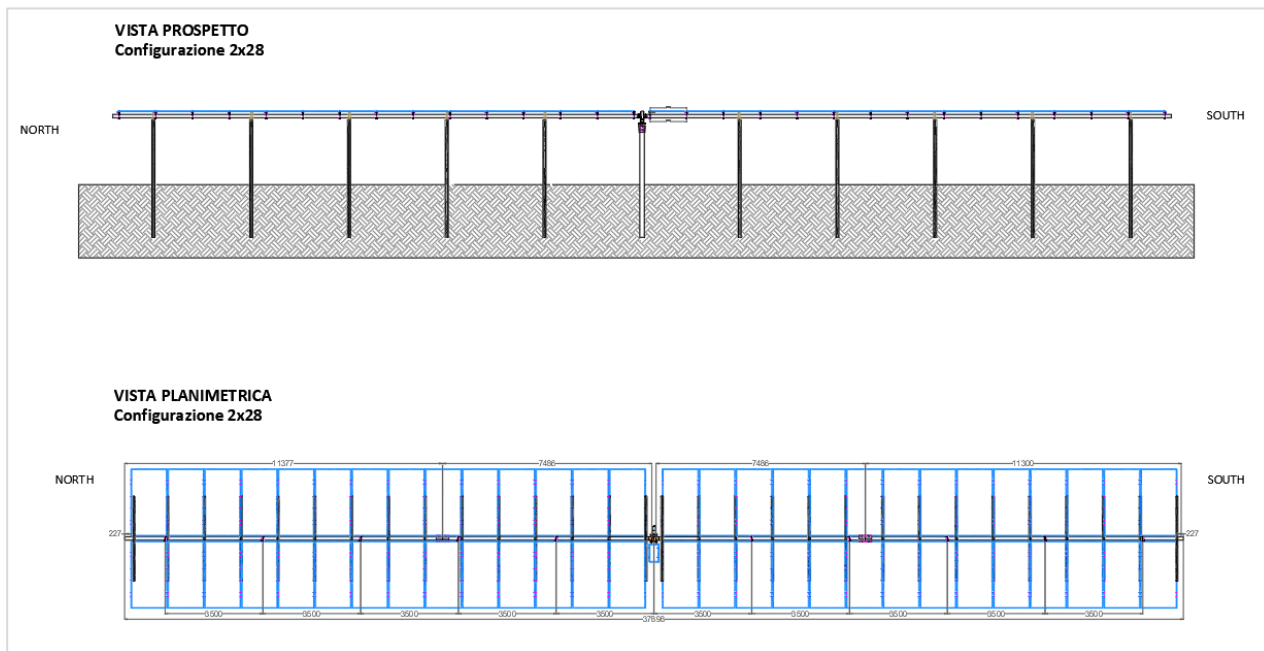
Vista del prospetto e planimetrica delle strutture porta-moduli tracker 2x28
